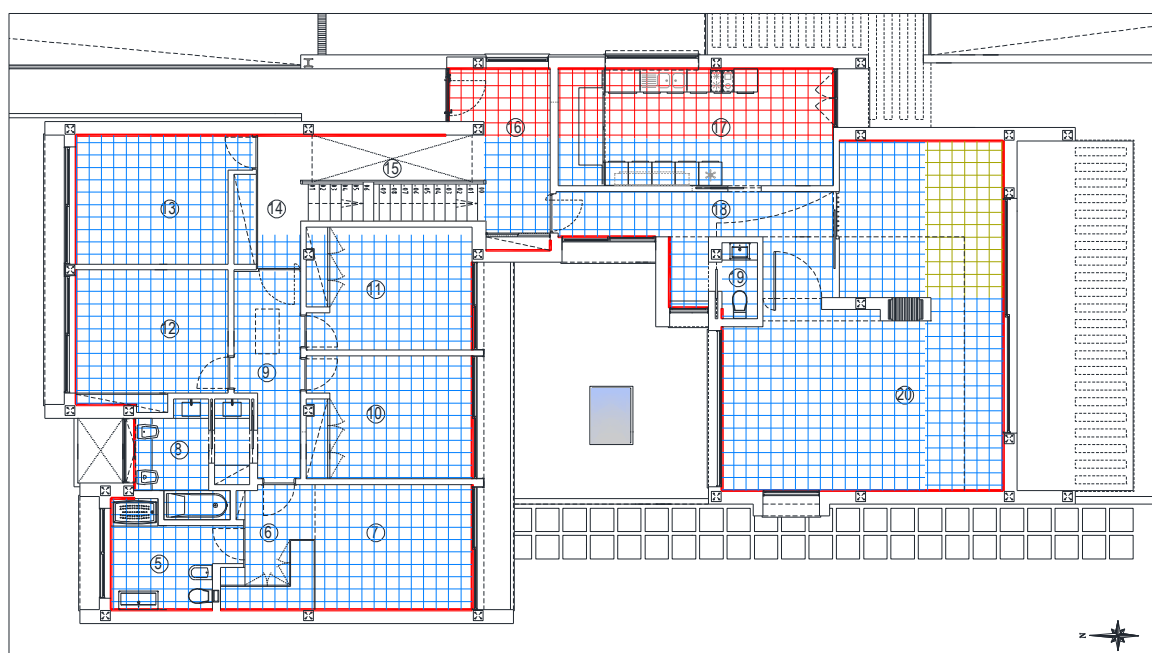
Planta do piso 0 com a delimitação da envolvente ao nível do piso.
